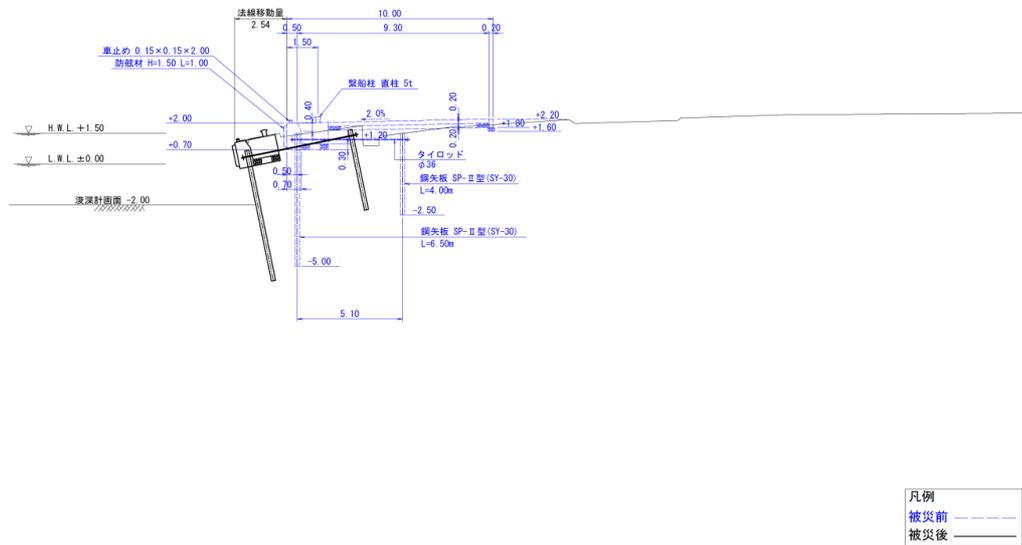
No.15 日立港区_第5埠頭地区第2船だまりの西断面図 (被災前・後)
